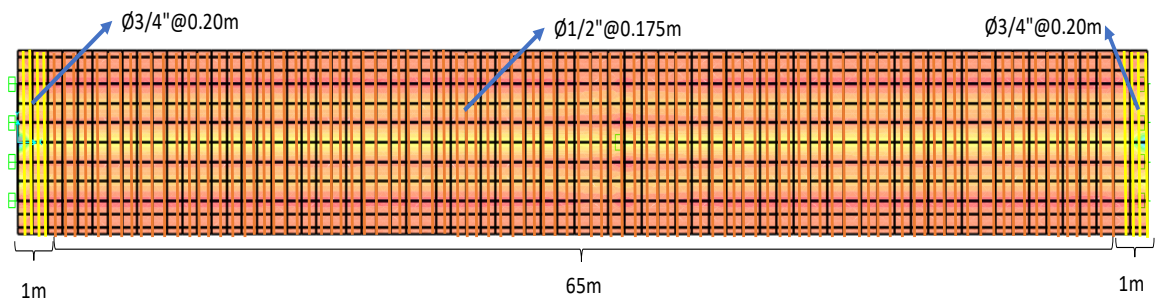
Distribución de acero de refuerzo inferior transversal en losa
